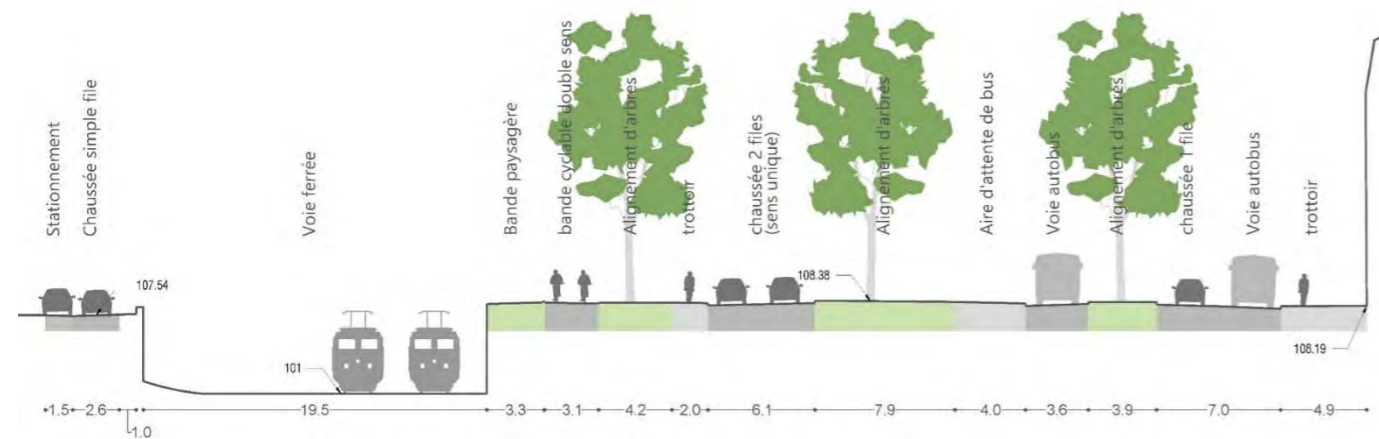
Profil existant du boulevard Saint-Euverte (Source : groupement AMO – étude Plan Guide 2023)
